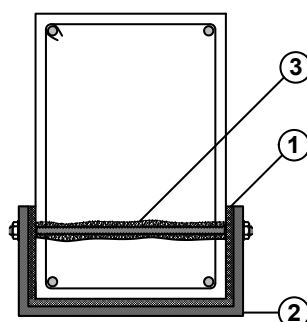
Tipologia 5: representação da secção transversal da viga reforçada. Legenda: 1 – resina epóxi; 2 - chapa metálica; 3 – buchas metálicas.
